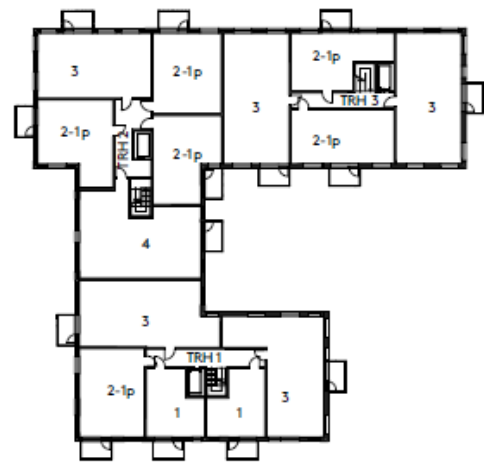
Illustrationsplan, ÅWL Arkitekter.
